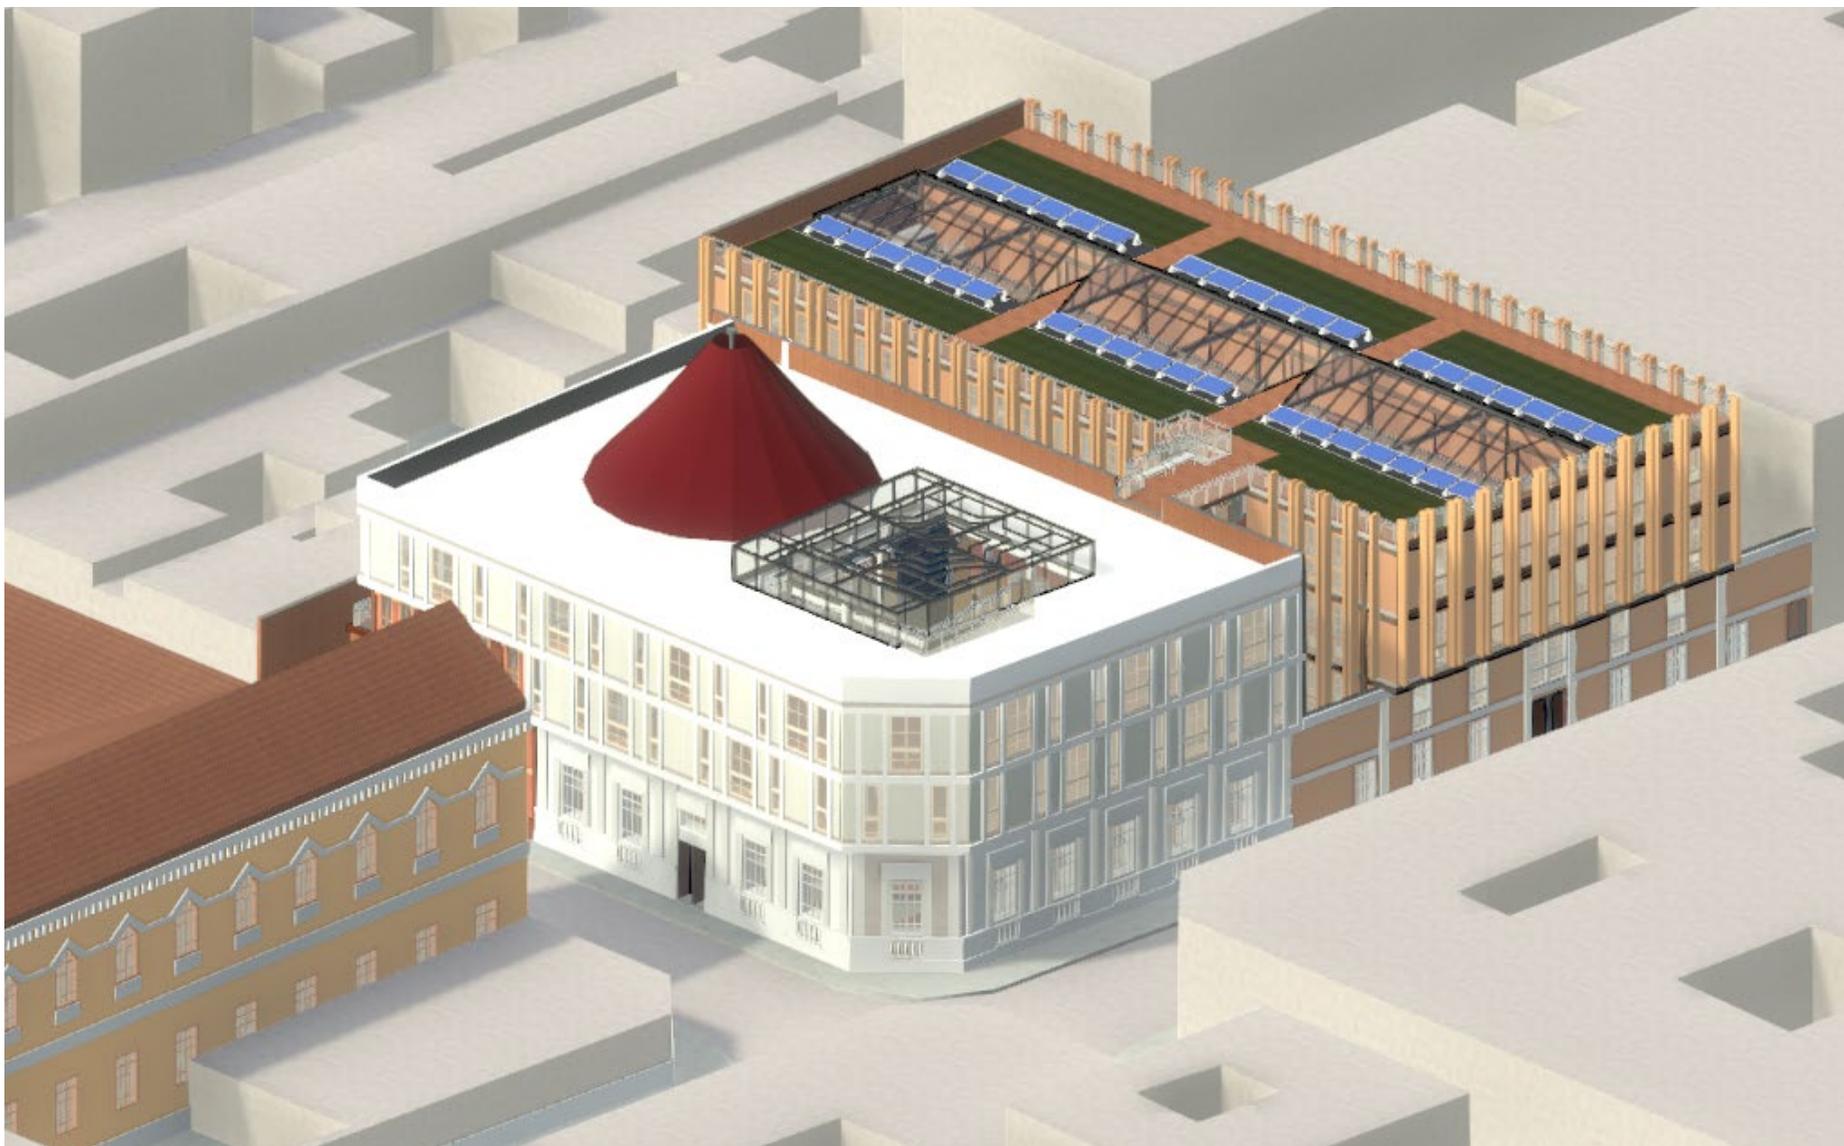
Render 3D, Propuesta Arquitectónica, “Espacio Compañía.”
